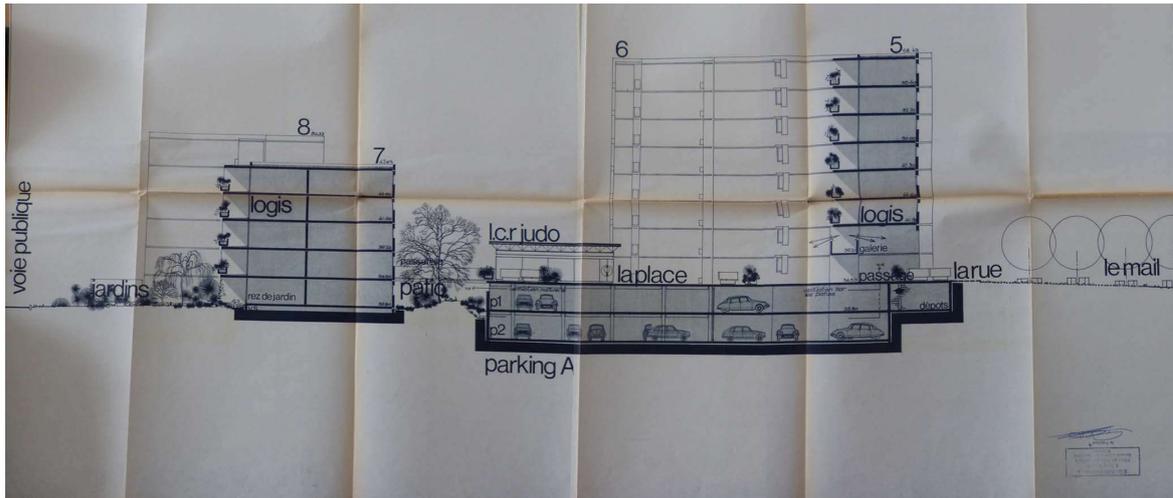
Coupe « Parking – Place – Rue – Mail ». AMVA / Fonds 340W22.
